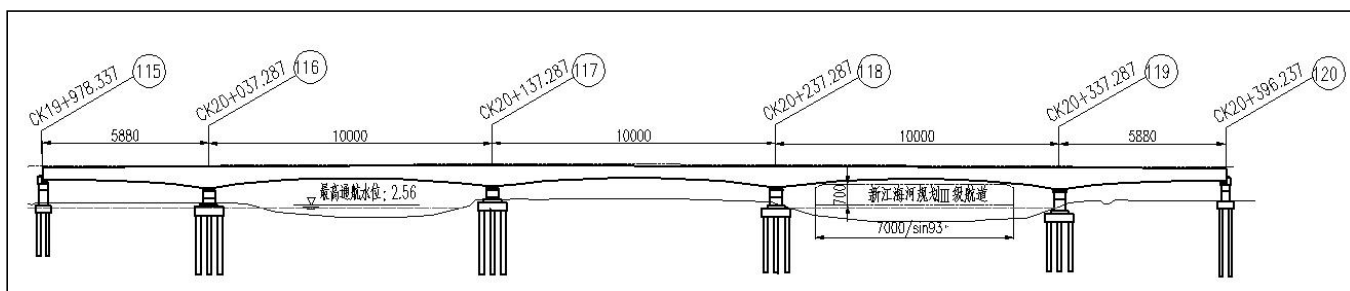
跨新江海河桥梁立面图 (单位: cm)
